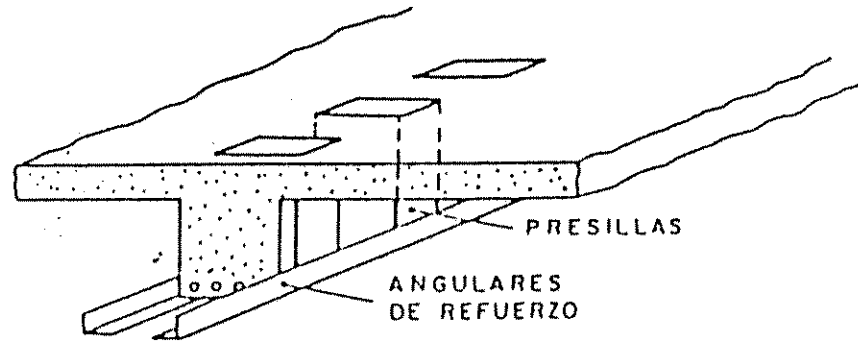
Refuerzo mediante elementos metalicos laminados.
